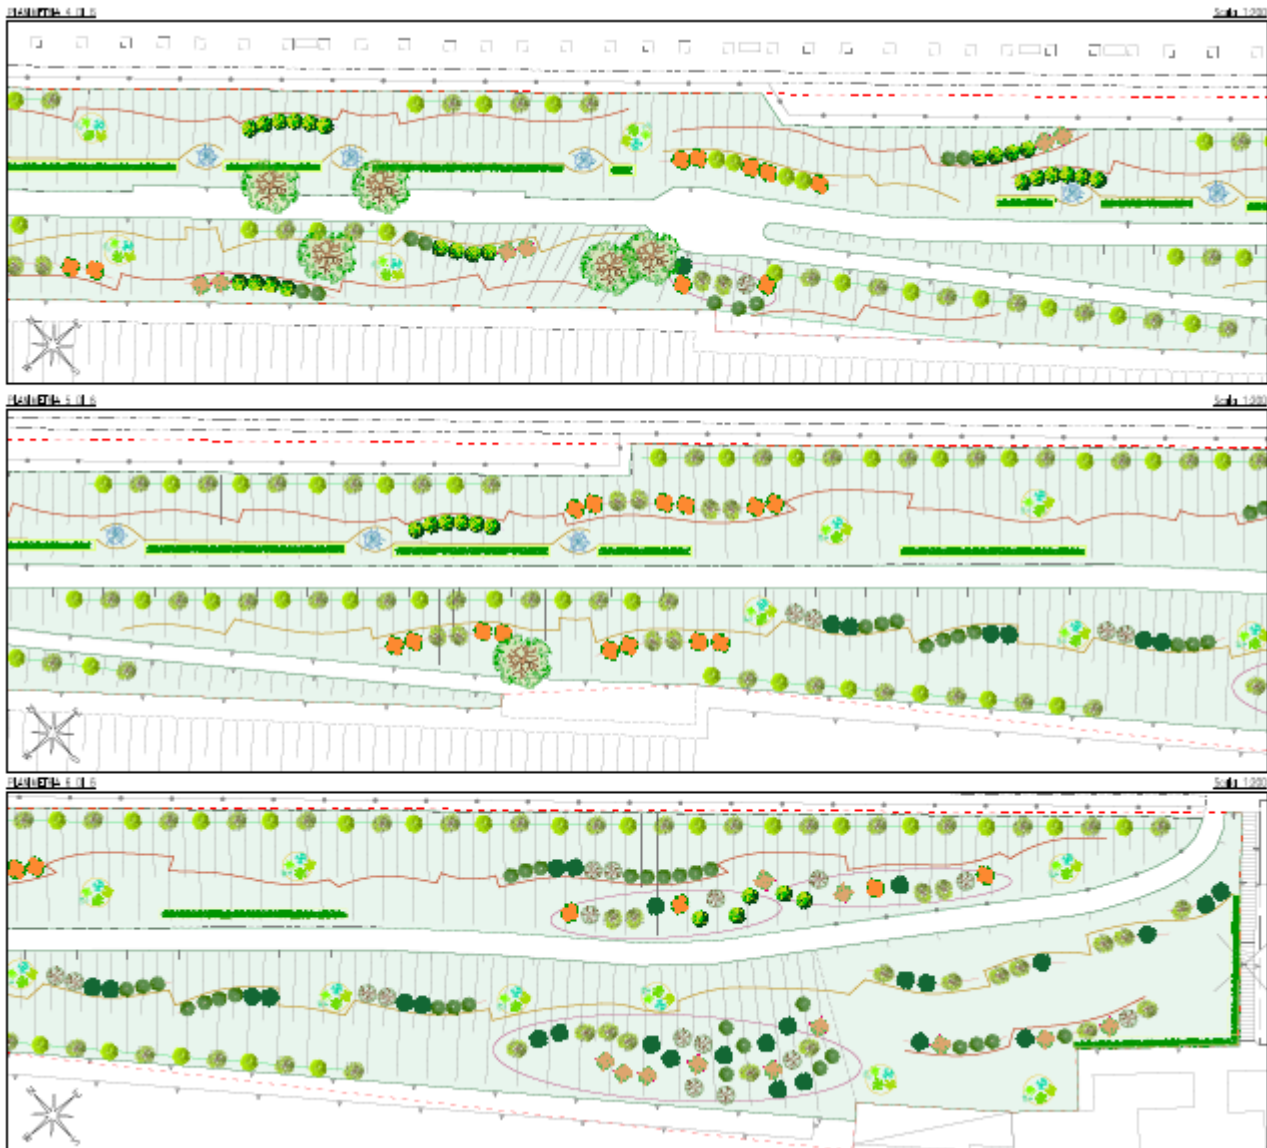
Estratto elaborato Planimetria opere verde (2 di 2)
